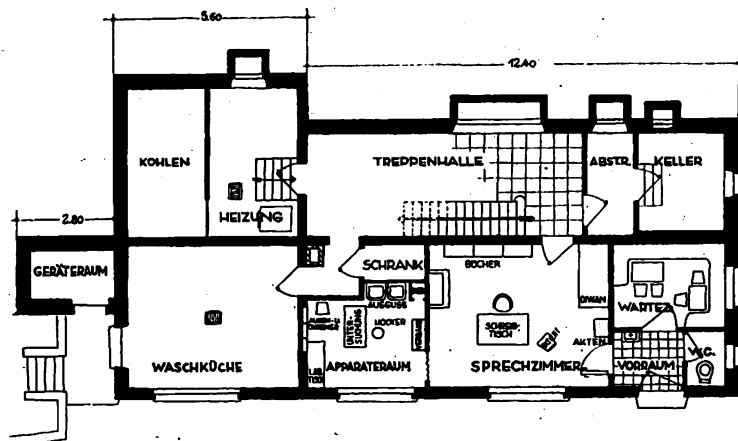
Arzthaus am Hang. Untergeschoß im M. 1:200 (ca.). Praxis im Untergeschoß mit besonderem Eingang. Wohnung in Erd- und Dachgeschoß.
